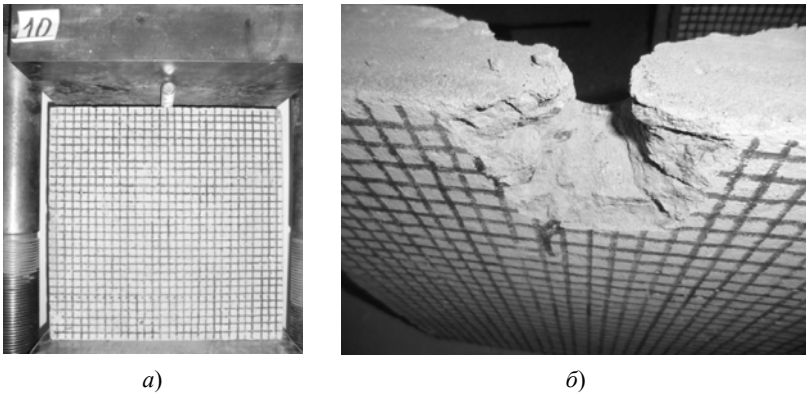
Испытание модели стены, армированной арматурной сеткой, под действием сосредоточенной нагрузки:
